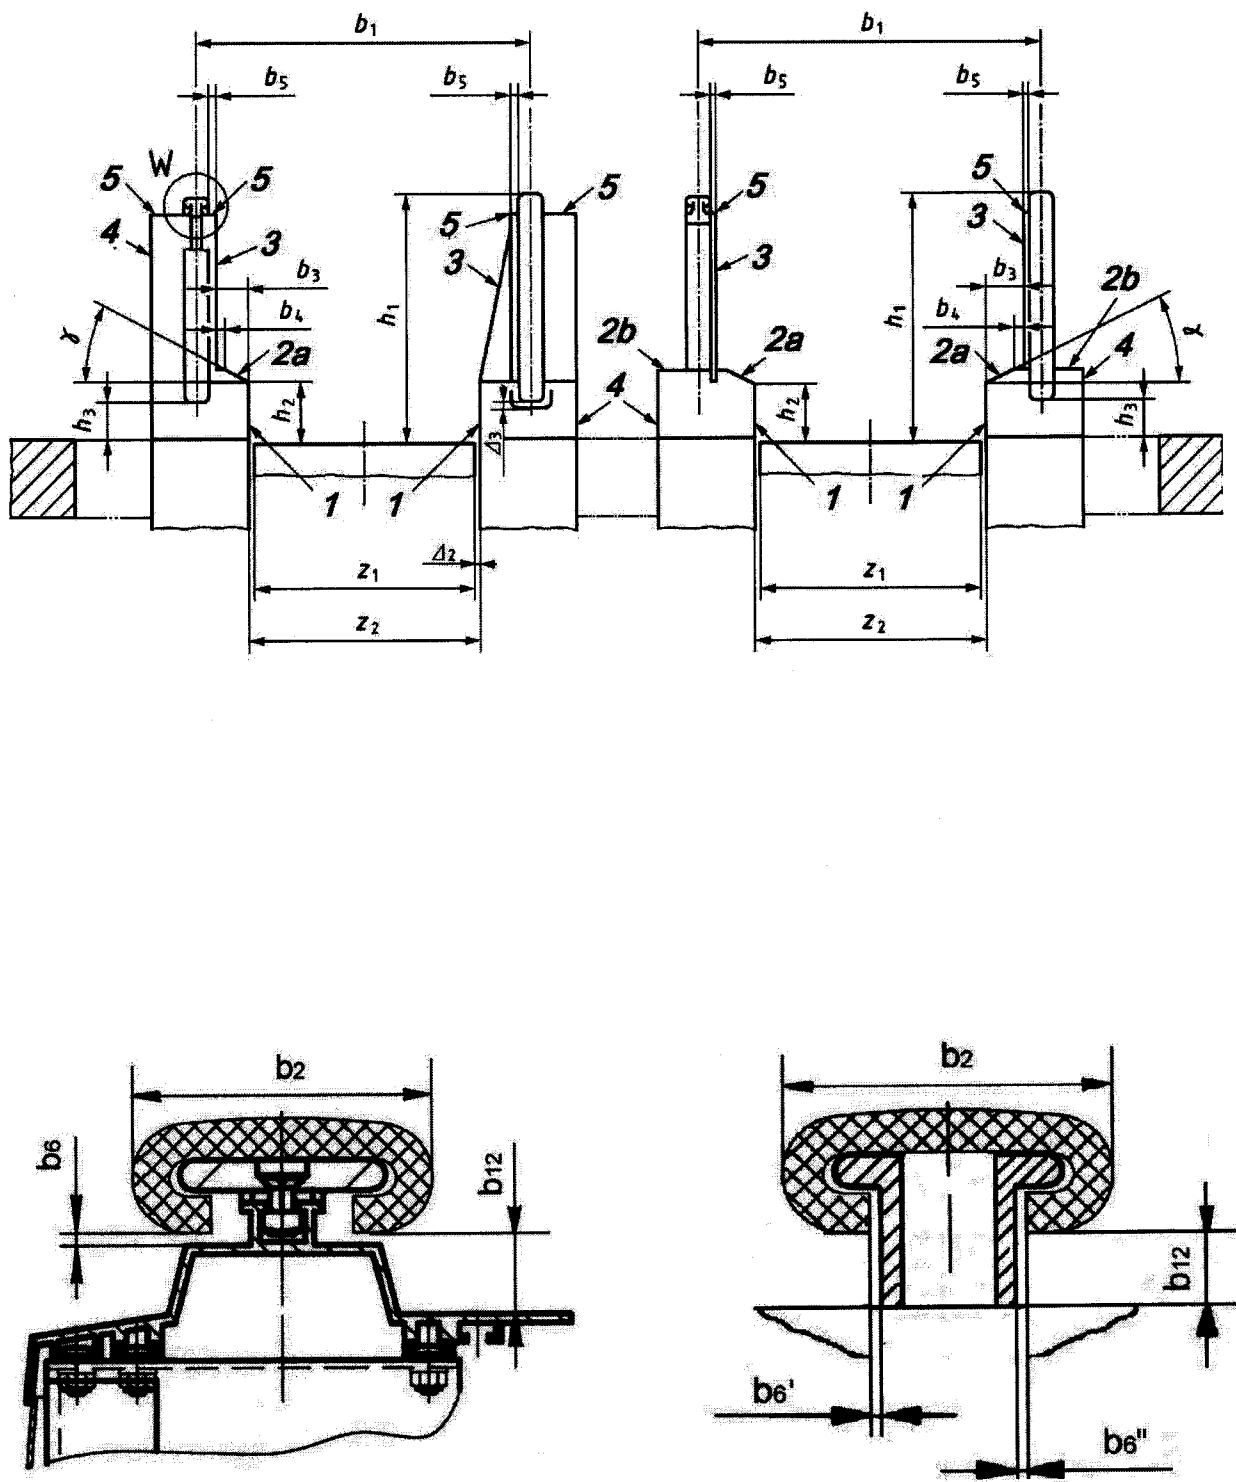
Эскалатор (вид в разрезе), основные размеры
